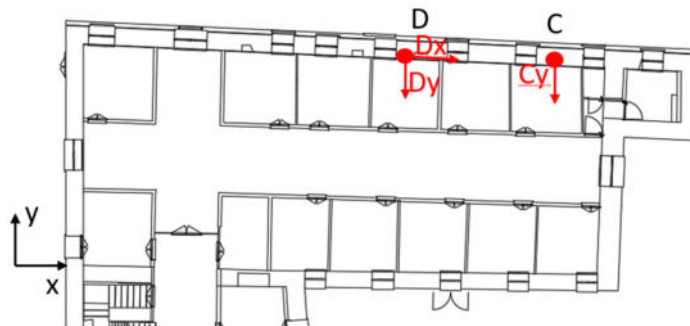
Disposizione accelerometri nel piano primo dell'edificio.
